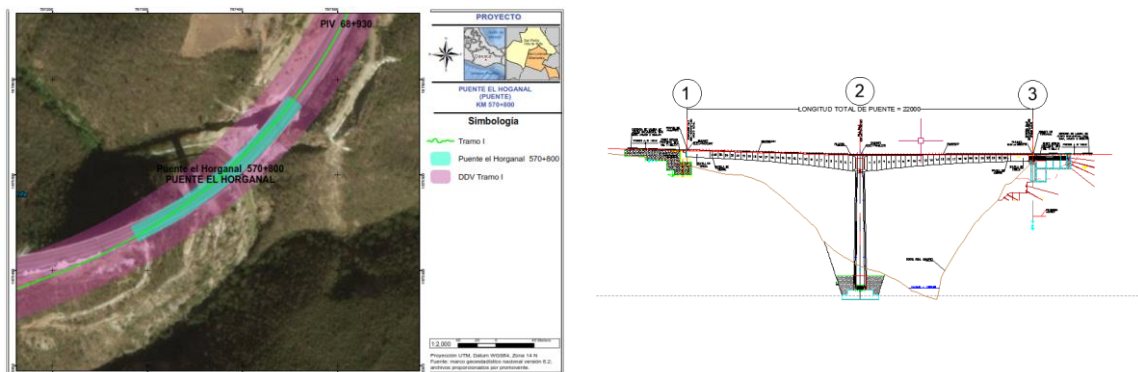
Proyecto en planta y de perfil del Puente el Horganal 570+800.
